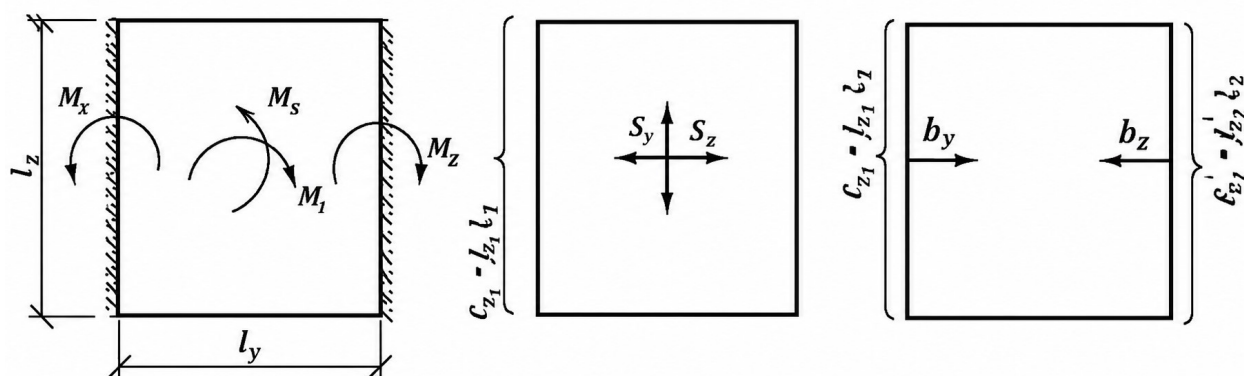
Схеми дії моментів, розподілу пролітної і опорної арматури в плиті перекриття, затисненої по двох сторонах і двом вільним сторонам
